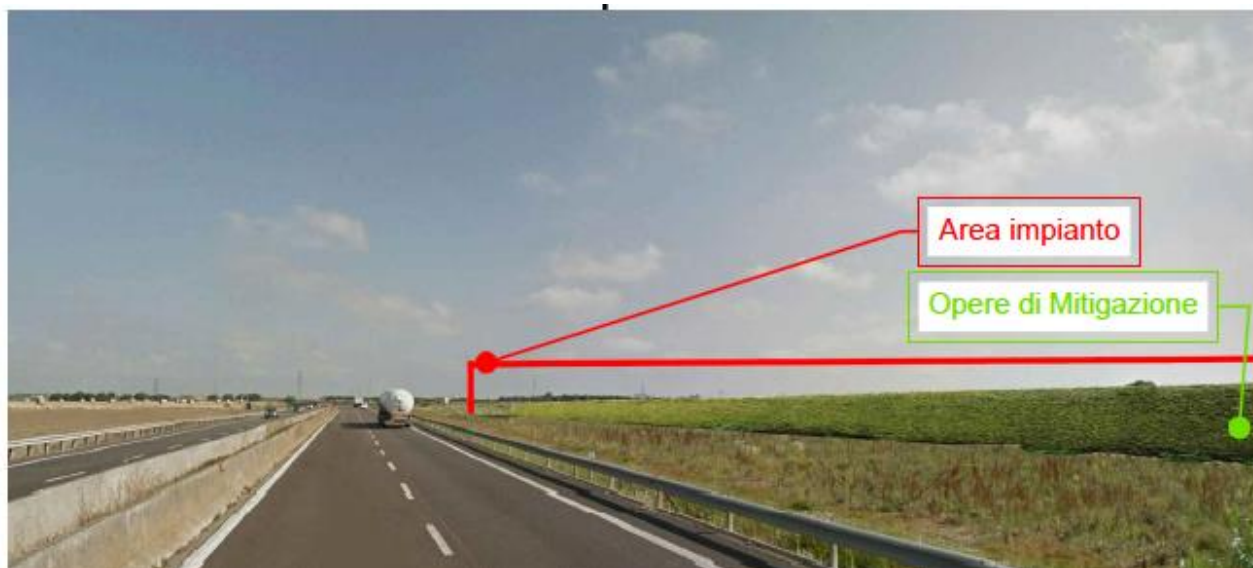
Foto inserimento dell'impianto fotovoltaico dalla SS 613
